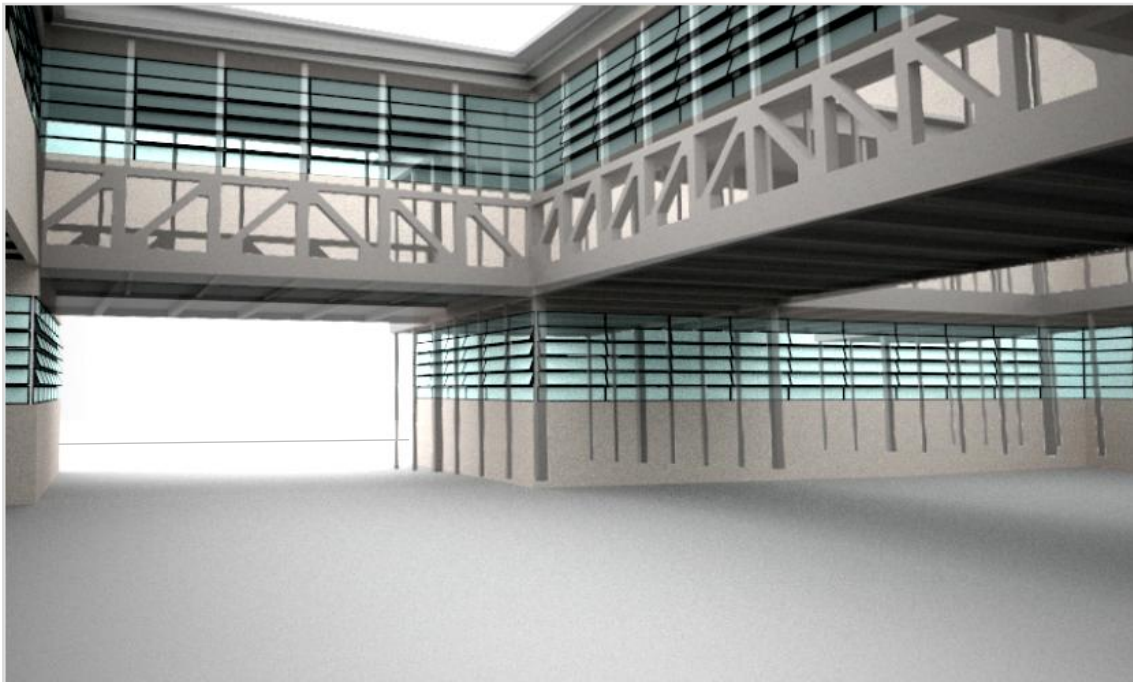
Montagem da estrutura e arquitetura. Fonte: Autor, 2014.
